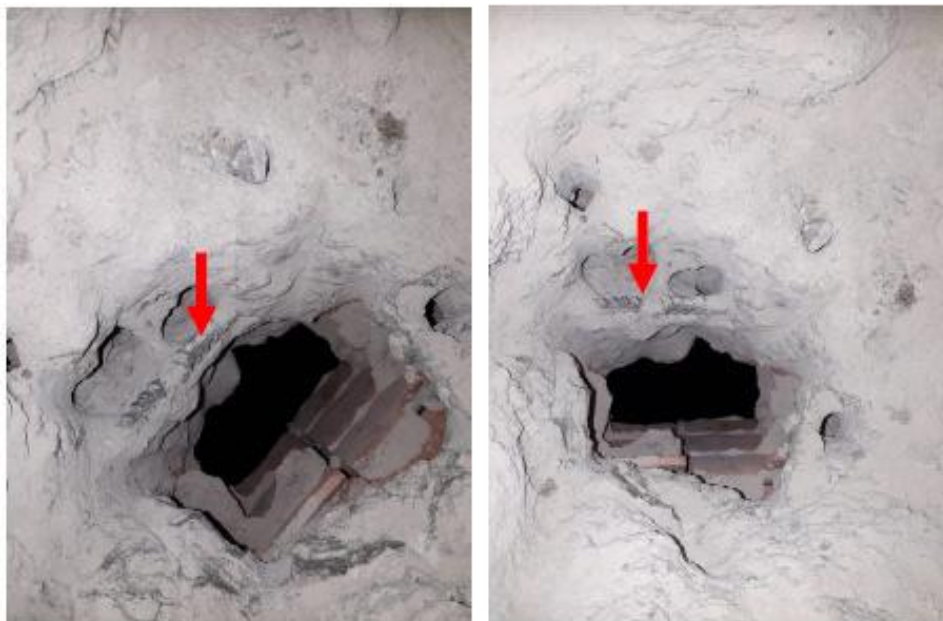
Saggio sul solaio a pavimento a lato del palcoscenico dove verrà realizzata nuova rampa accesso palco
